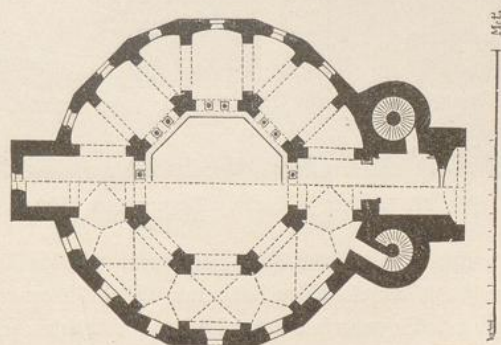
Palast-Kapelle in Aachen. Grundriß.
